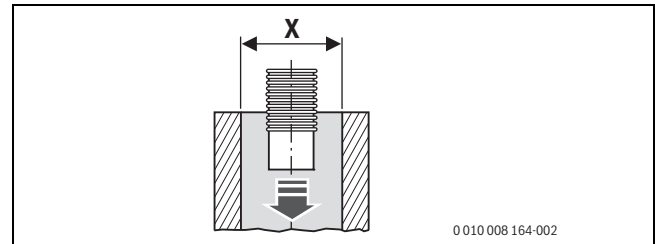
Mindestmaße des Schachtquerschnitts für die Montage der flexiblen Abgasleitung bis Kesselgröße 50 kW (Maße in mm)
